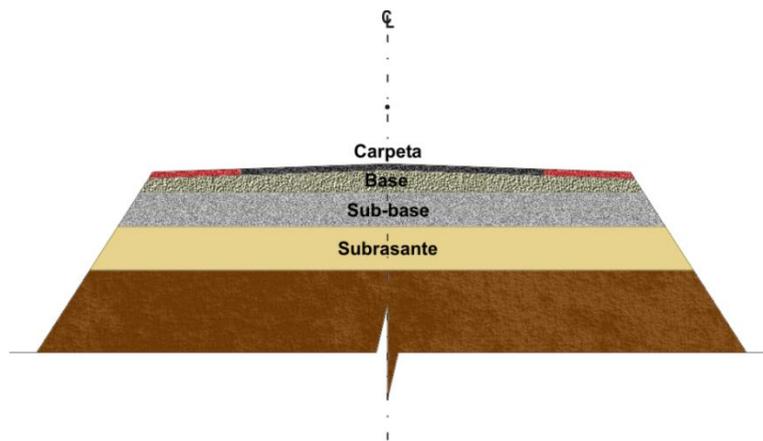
Estructuración típica de un pavimento flexible¹
